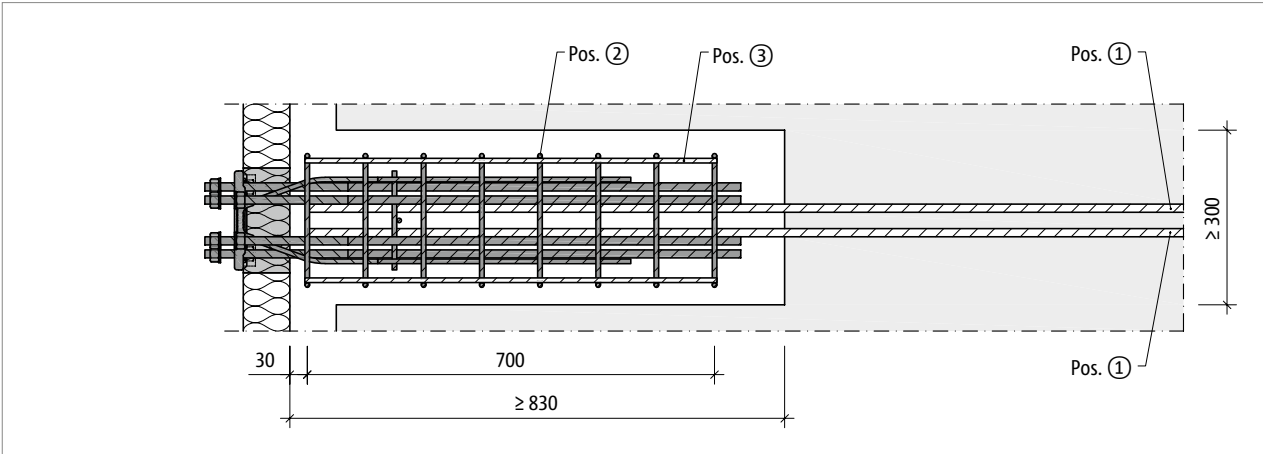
Schöck Isokorb® T Typ SKP-MM1-VV1: Bauseitige Bewehrung bei Halbfertigteilbauweise, Grundriss
